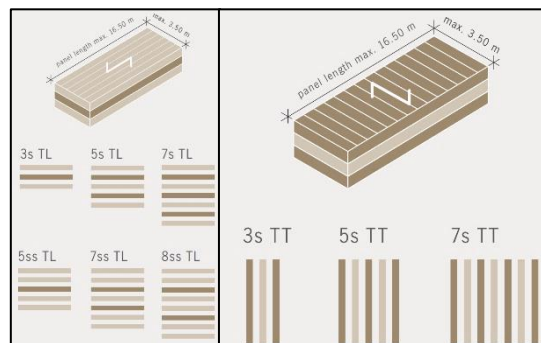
Painéis horizontais e verticais da KLH [5]
